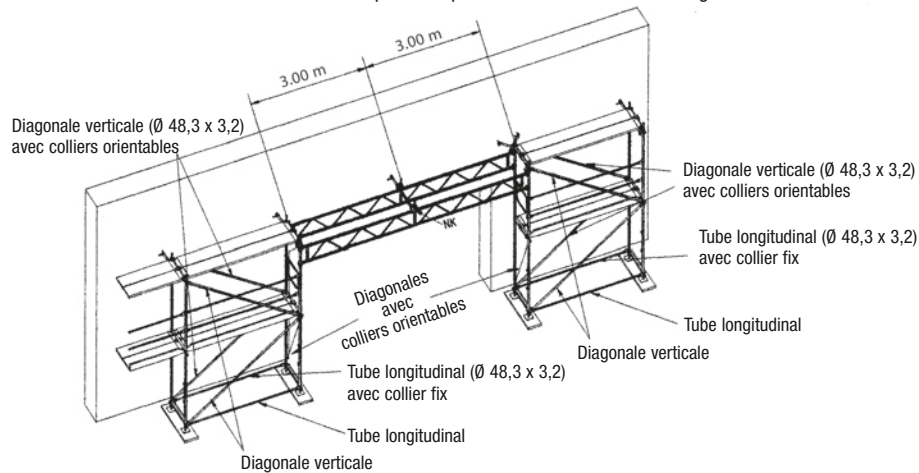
Renforcement de la membrure supérieur par ancrage dans la façade.
